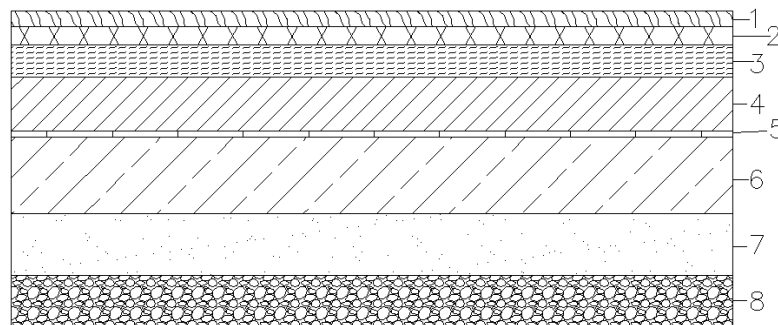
Конструкция перекрытия пола по грунту
